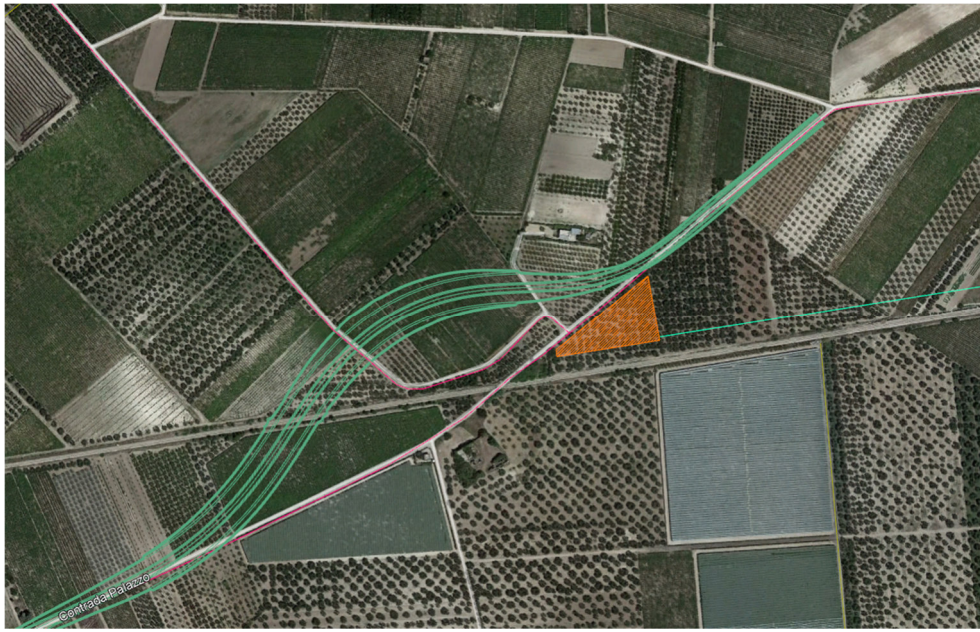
vista dell'area di cantiere AT.04 (fonte Google Earth)
